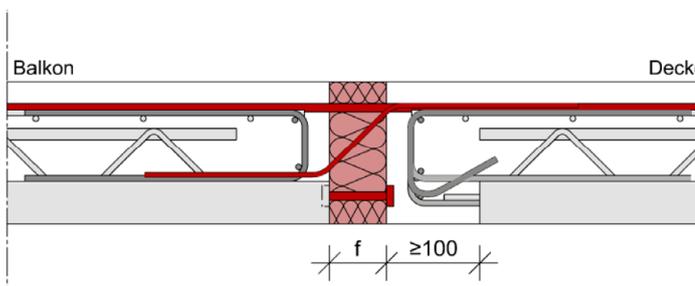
Einbau Egcobox in Elementdecken – Querkraftstabschenkel auf Elementdeckenspiegel und Bügelvarianten wie in B - 4 bis B - 6
